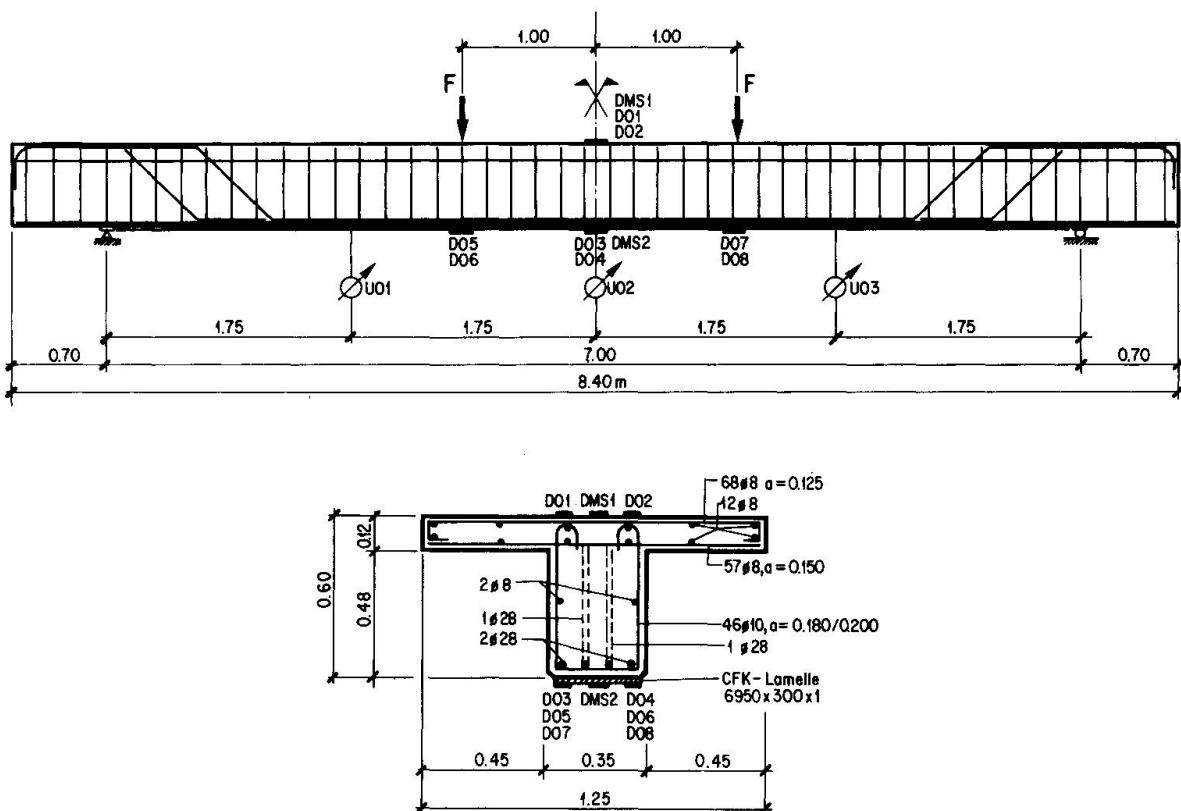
Versuchsbalken: Abmessungen, Bewehrung, Lastanordnung sowie Art und Lage der verwendeten Messinstrumente
